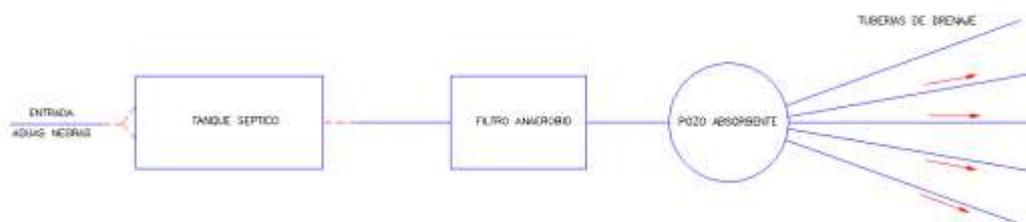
Vista en planta, esquema del funcionamiento de la planta de tratamiento
